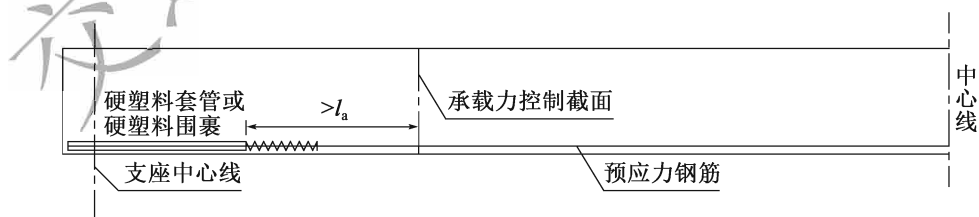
Exigence sur la longueur d'ancrage des armatures de pré-tension
